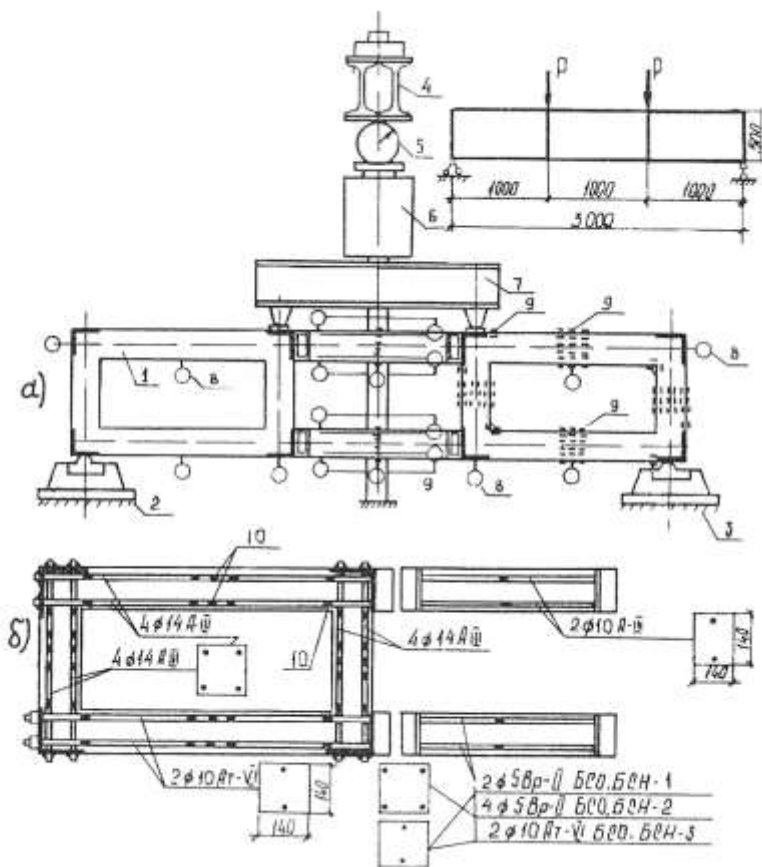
Схема завантаження і розташування приладів при дослідженні зразків рам: а – схема дослідження і конструкції дослідного стенда; б – схема розміщення тензодатчиків на арматурі; 1 – зразок при випробуванні; 2 – рухома опора; 3 – нерухома опора; 4 – упорна траверса; 5 – динамометр; 6 – гідравлічний домкрат; 7 – розподільча траверса; 8 – індикатори годинникового типу; 9, 10 – тензодатчики на бетоні та арматурі відповідно.
